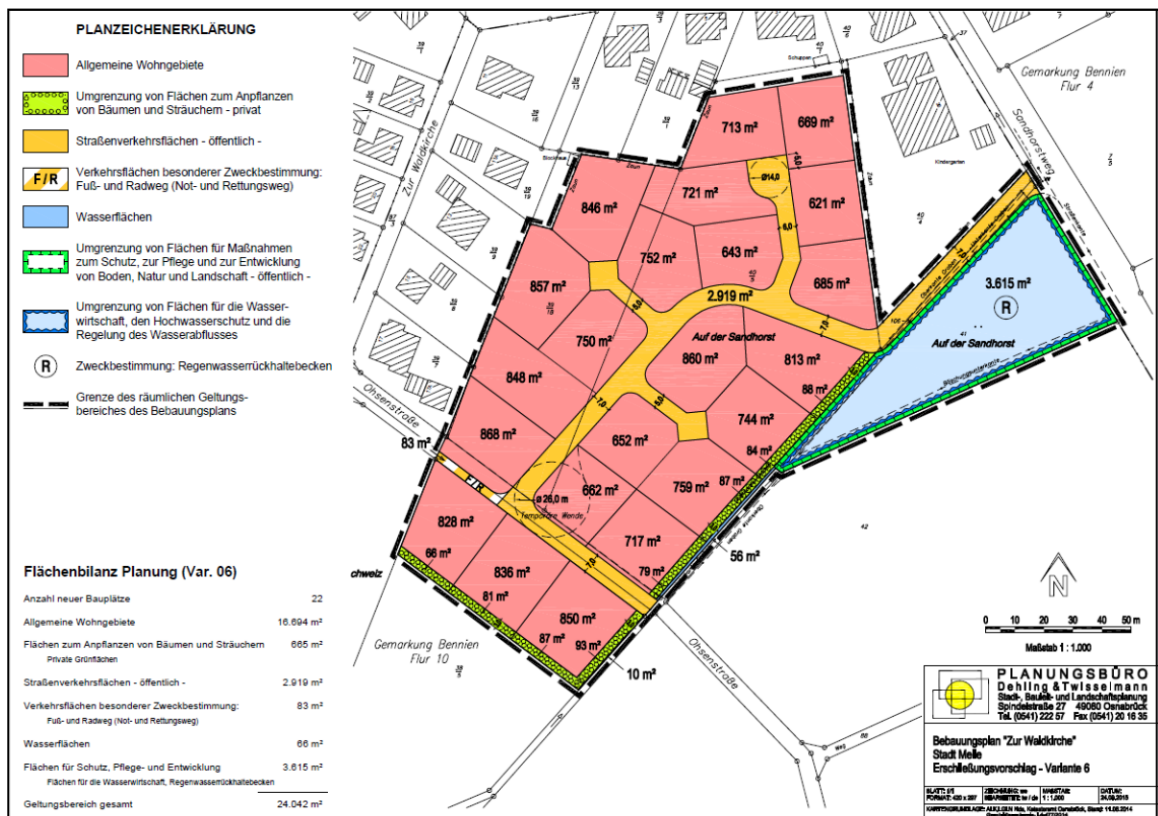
B.-Plan „Zur Waldkirche“; Quelle: Dehling und Twisselmann, o. Maßstab
